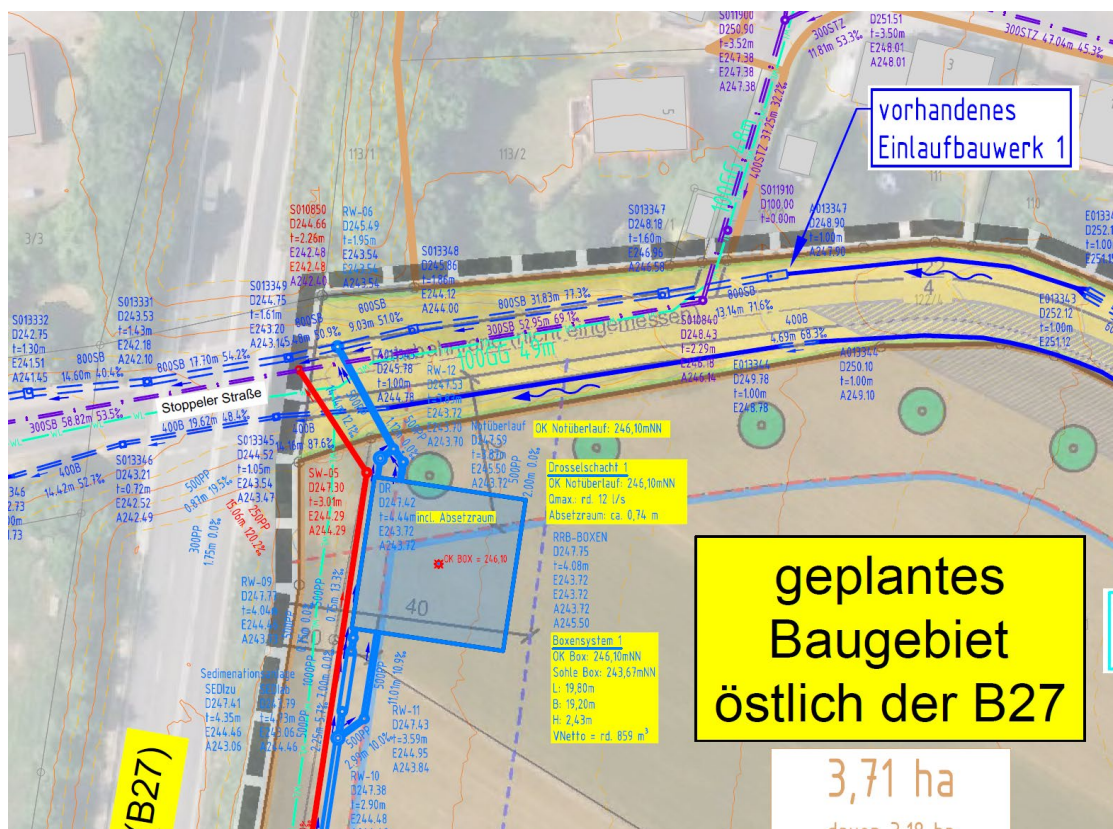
Vorschlag Lage unterirdisches Rückhaltesystem mit Anschluss an den RW-Kanal in der „Stoppeler Straße“
